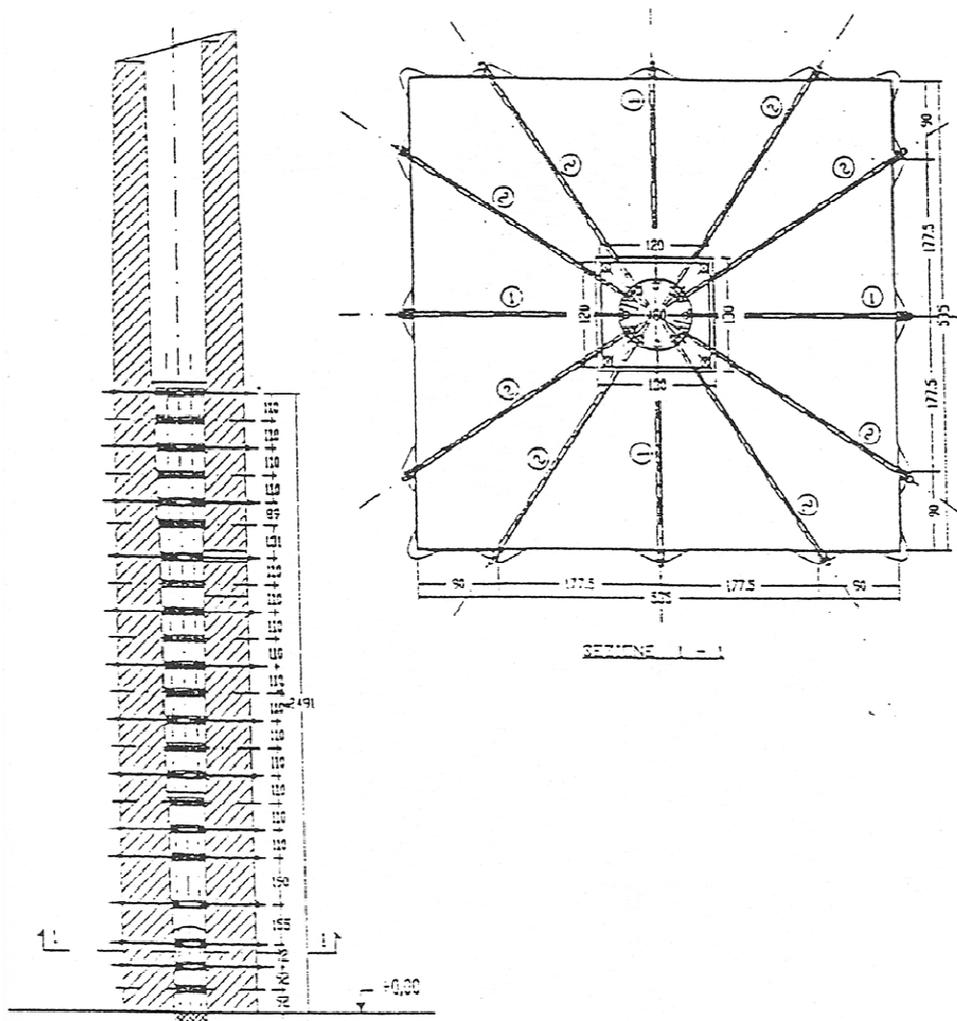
Torre Fraccaro: sezioni verticale ed orizzontale dell'intervento [16]
